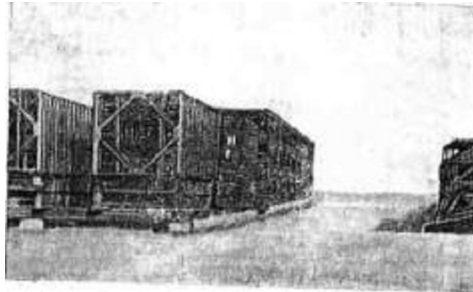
Общий вид площадки с конструкциями моста САРМ, уложенными в штабеля
